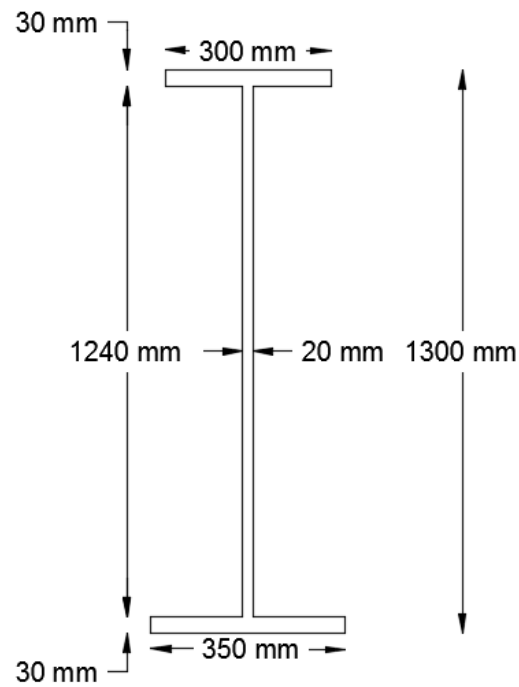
Medidas de la viga metálica longitudinal a diseñar. Realizado por: Autor
